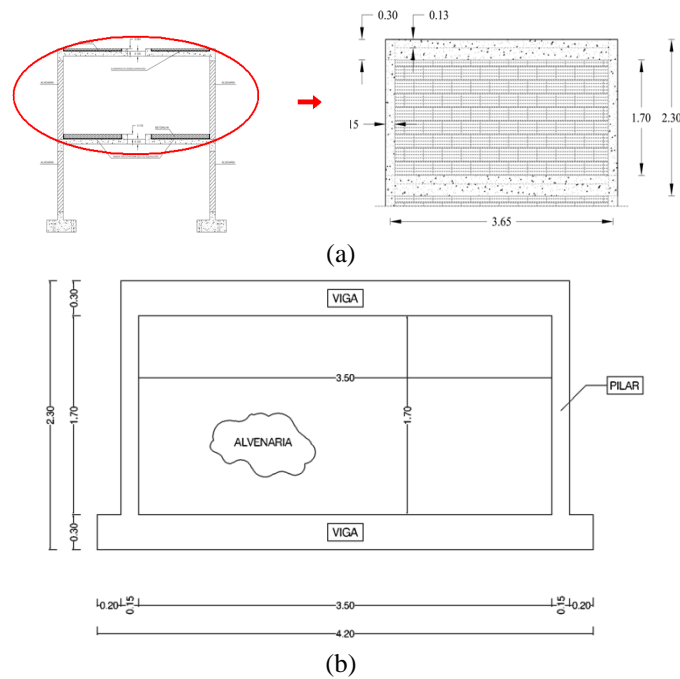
Caracterização dos painéis de alvenaria: (a) Localização; (b) Geometria.
